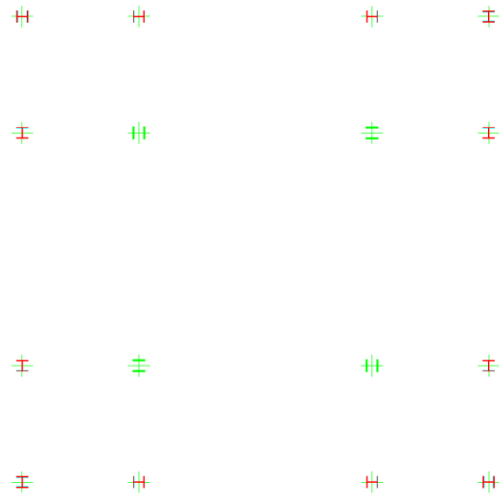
b Disposición de columnas en planta [elaboración propia]
